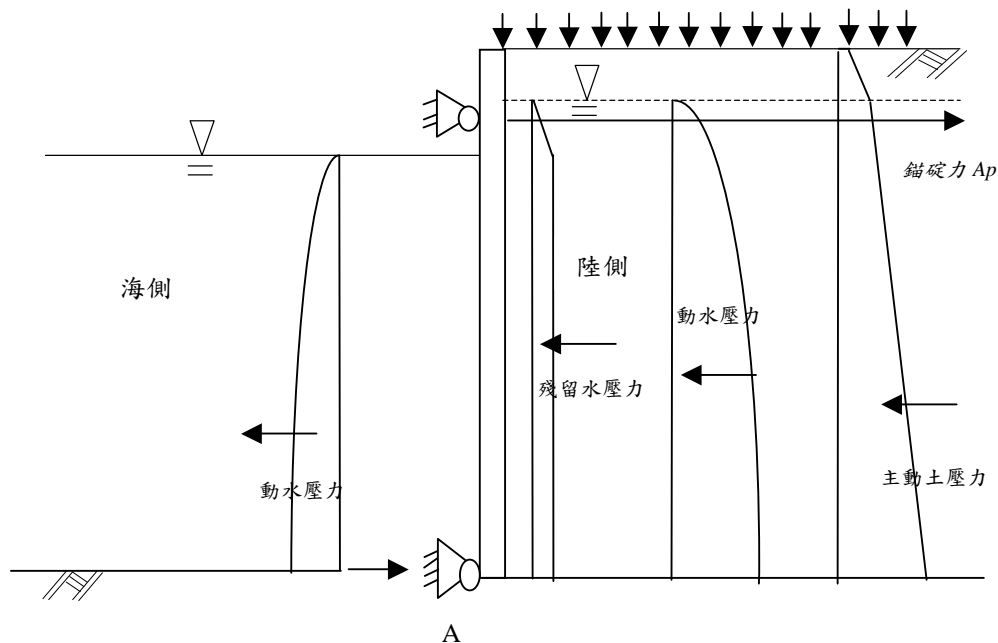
地震力作用下板樁最大彎矩與錨碇力計算示意圖
